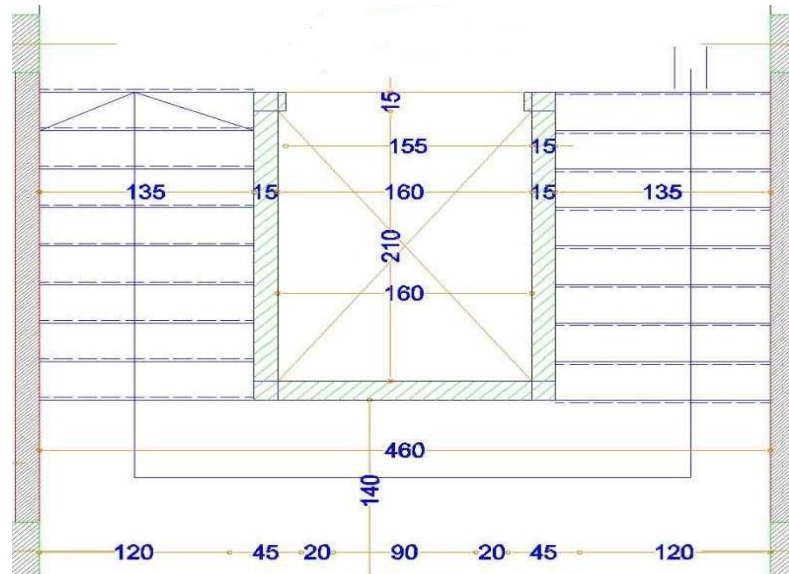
Vue en plan de l'escalier tirée du plan d'architecture.
